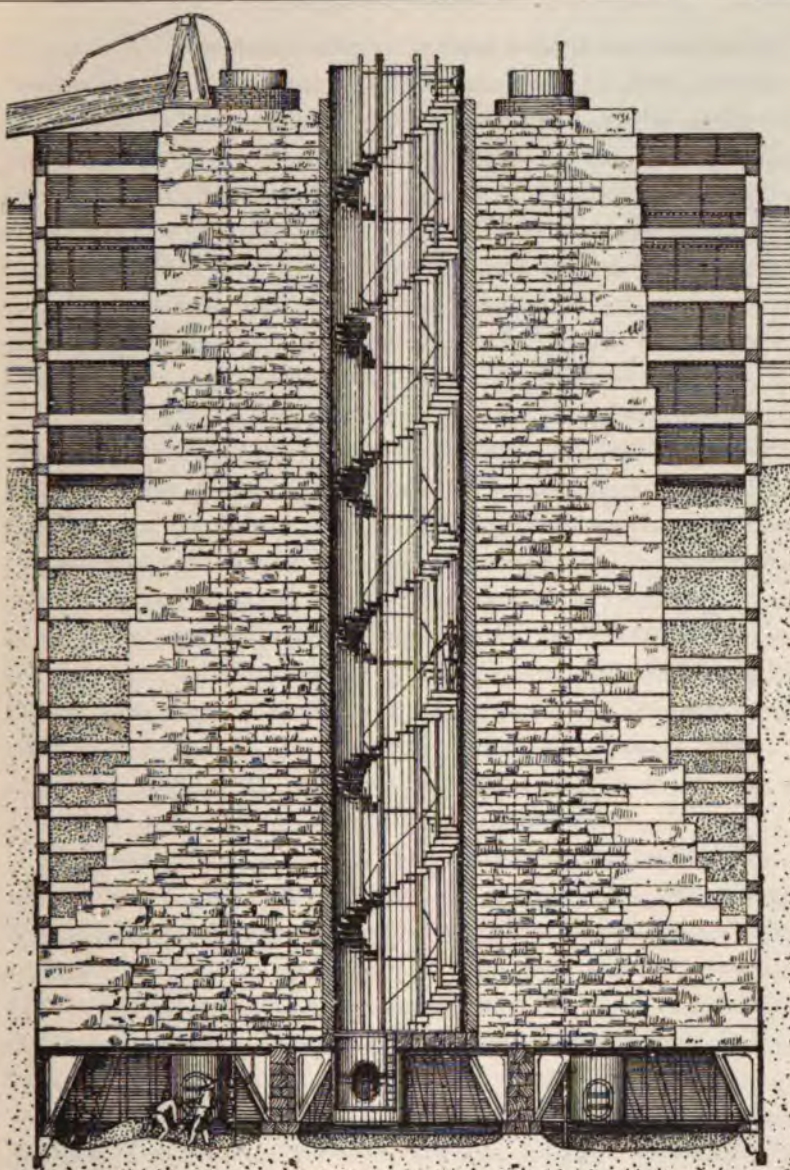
Travaux de fondation, par l'air comprimé, des piles du pont de Saint-Louis sur le Mississipi.
